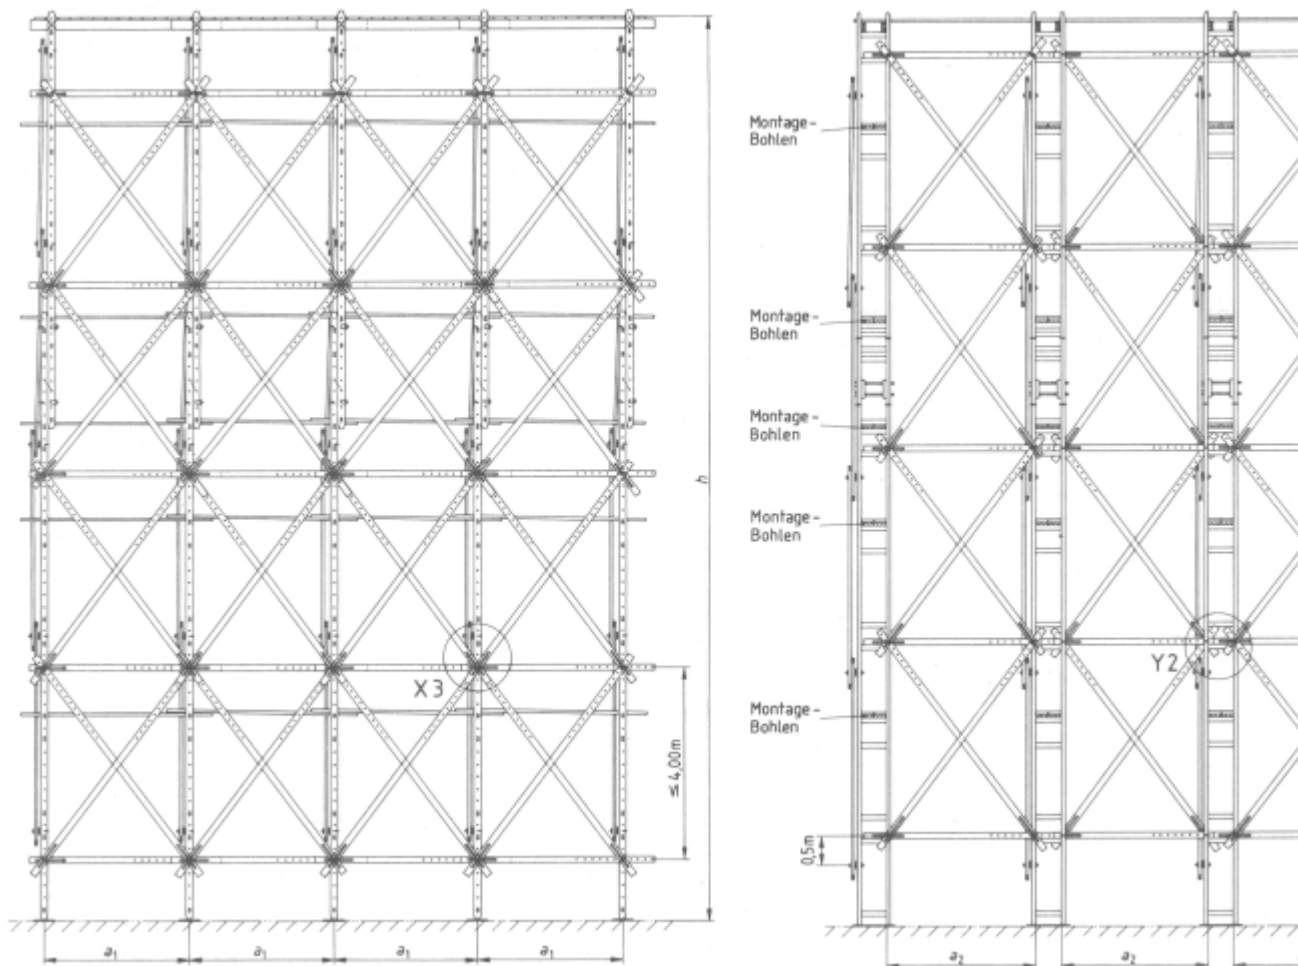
Raumgerüst (siehe [Abschnitt 5.2](#))
